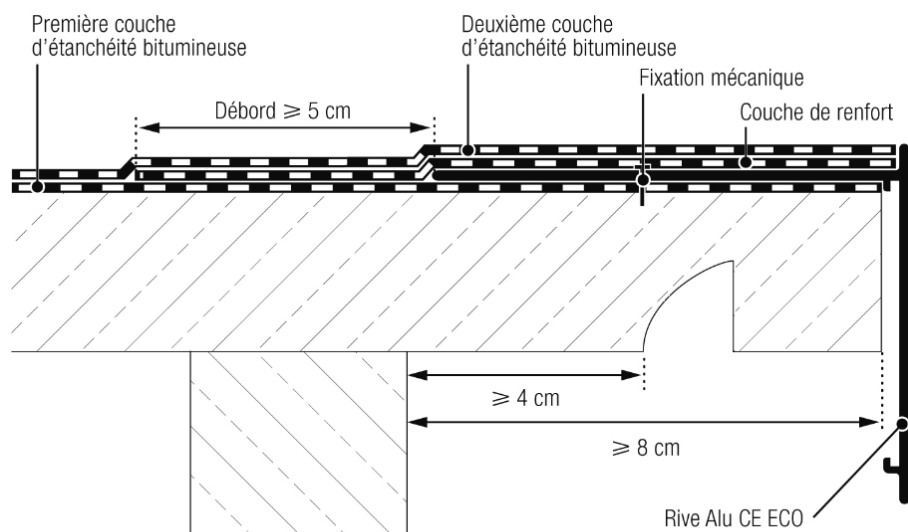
Bande de rive dans le cas d'une étanchéité bicouche bitumineuse
